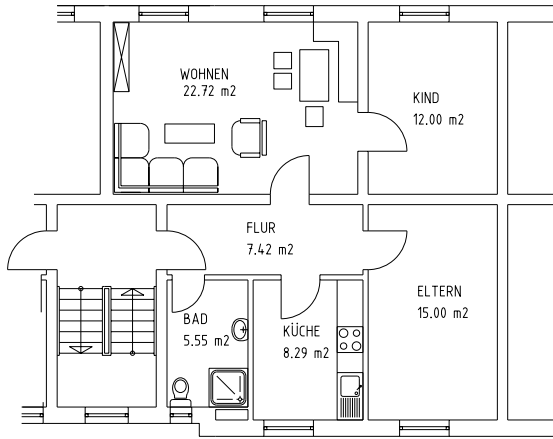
zeigt einen typischen Grundriss einer solchen Wohnung in der Herdstraße 1-3.
